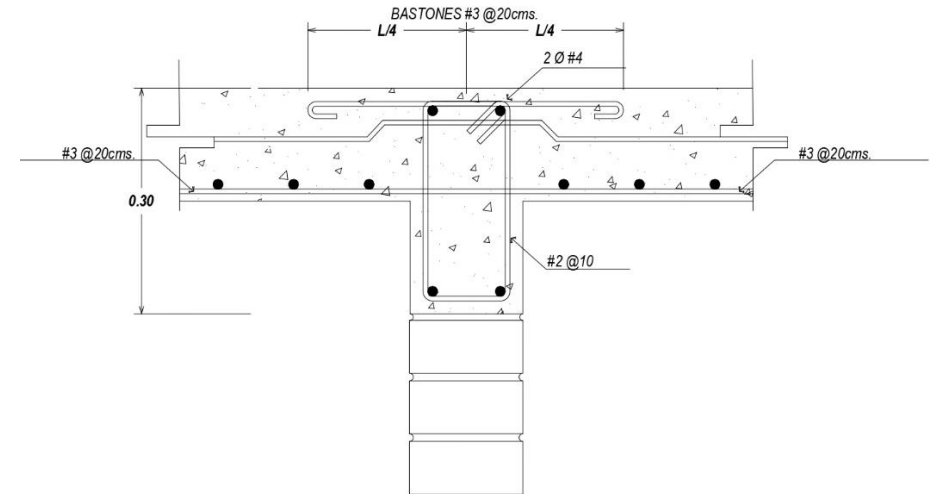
Sistema de losa maciza. (Loretto, 2021).
